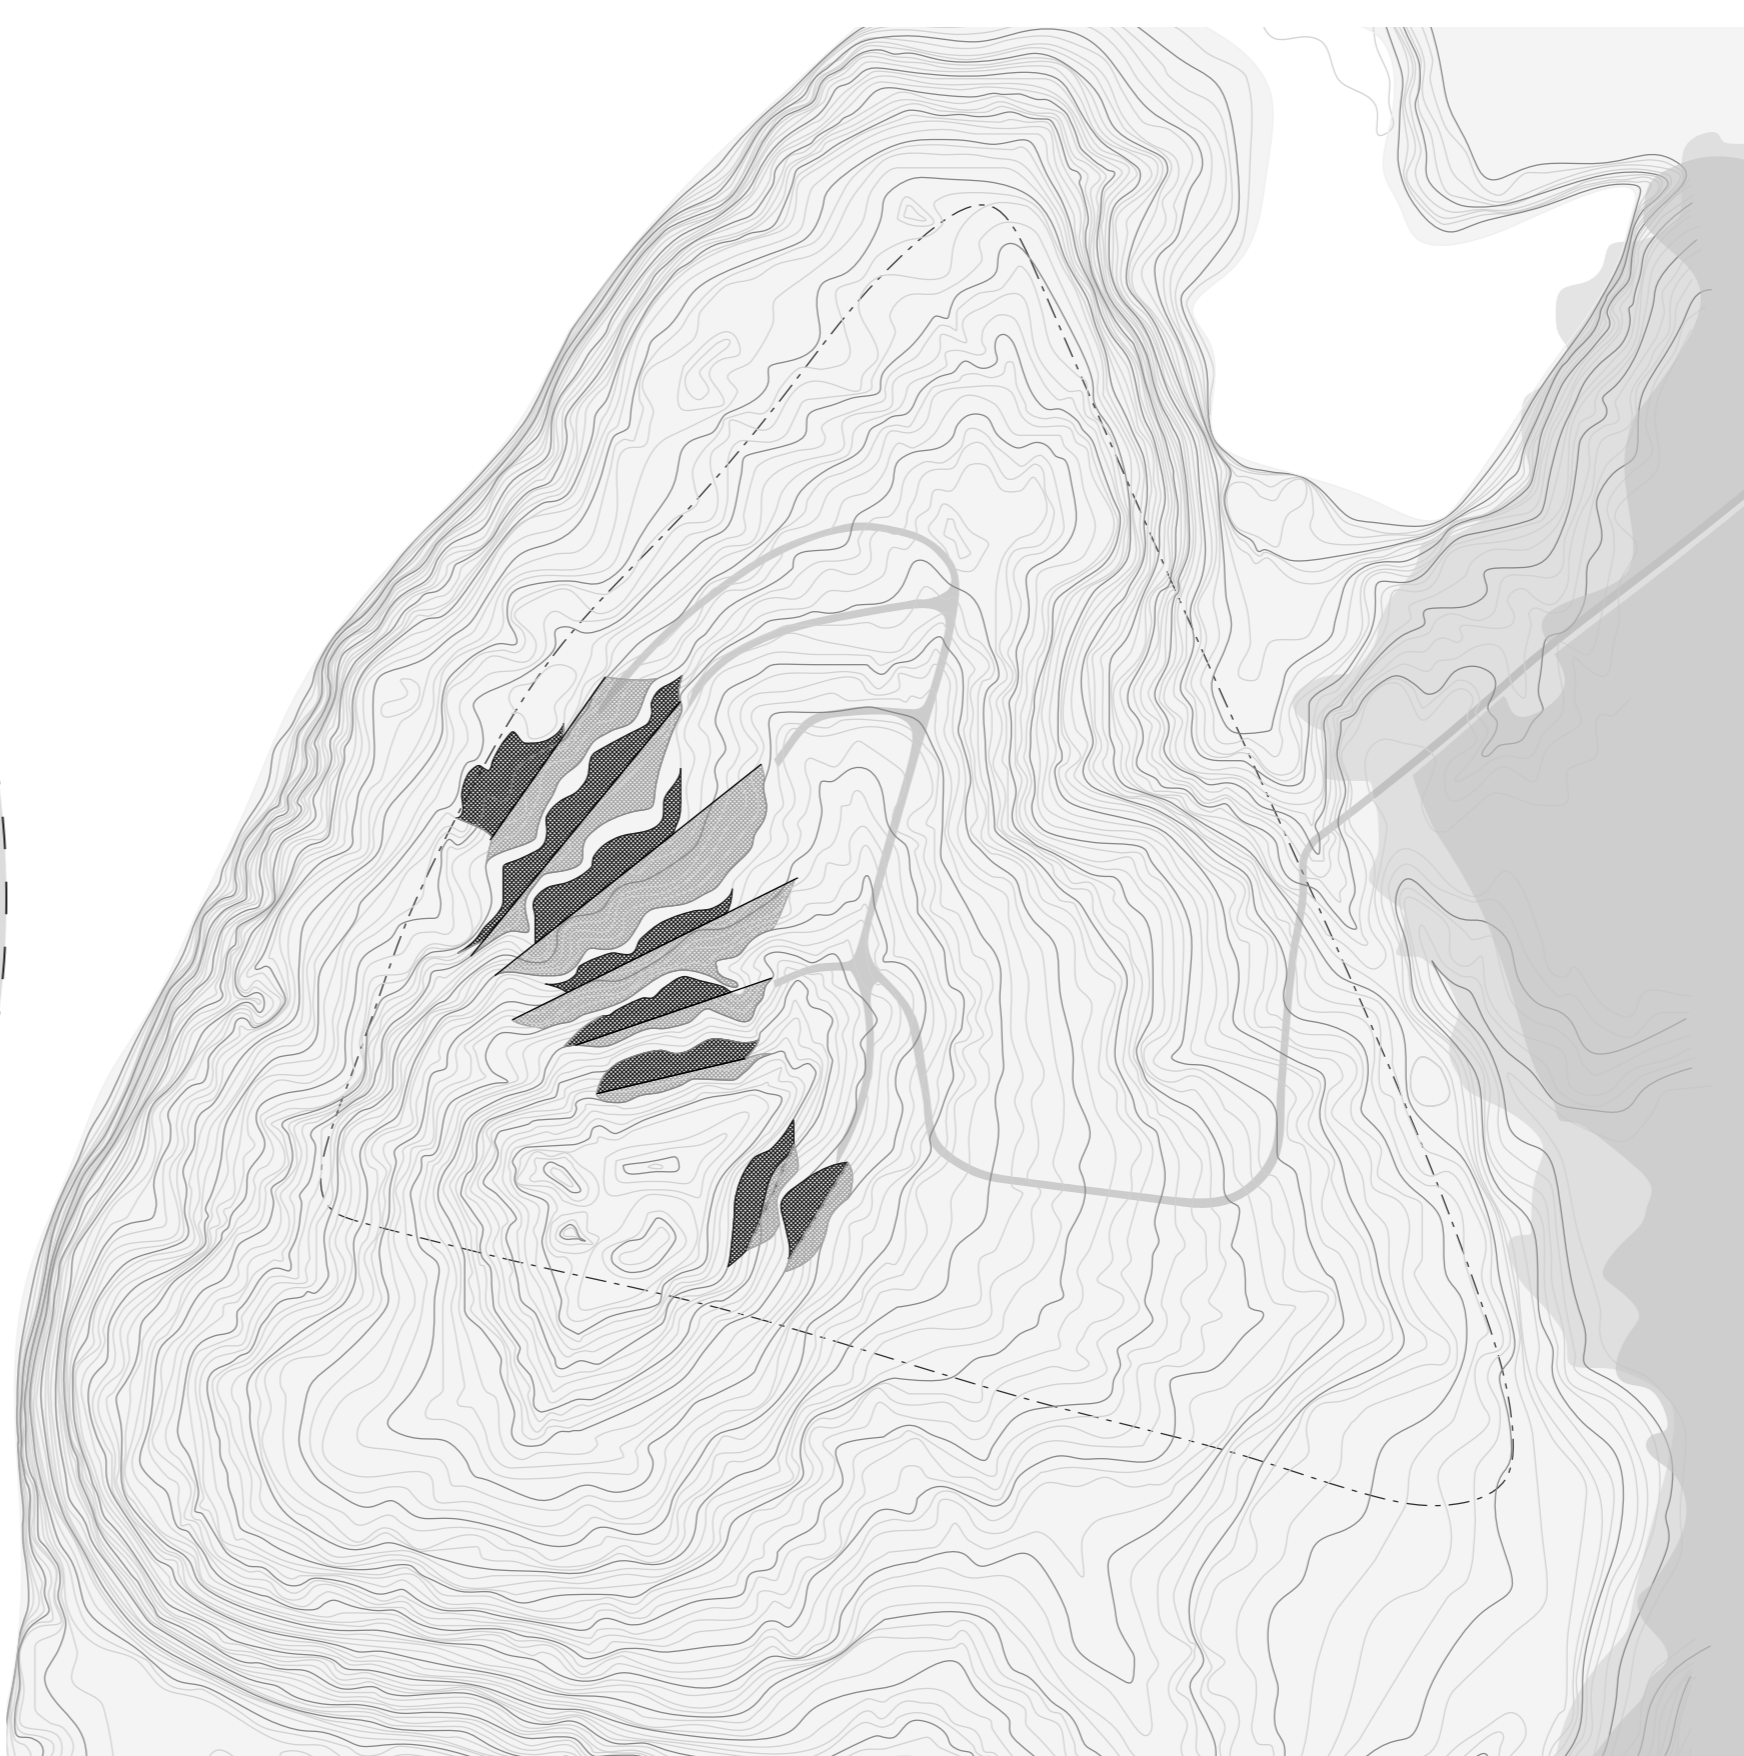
Emplaçament. Moviment de terres. Escala 1/2500
